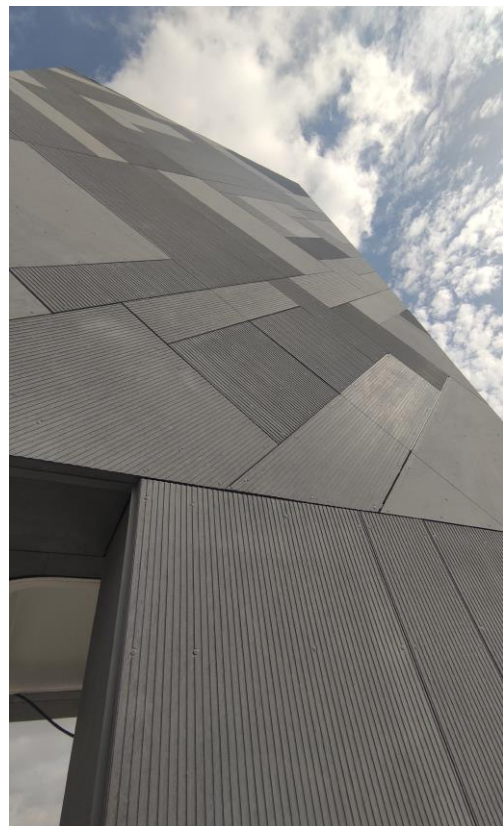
Detalle de acabado de fachada desde puerta de acceso a la torre.
